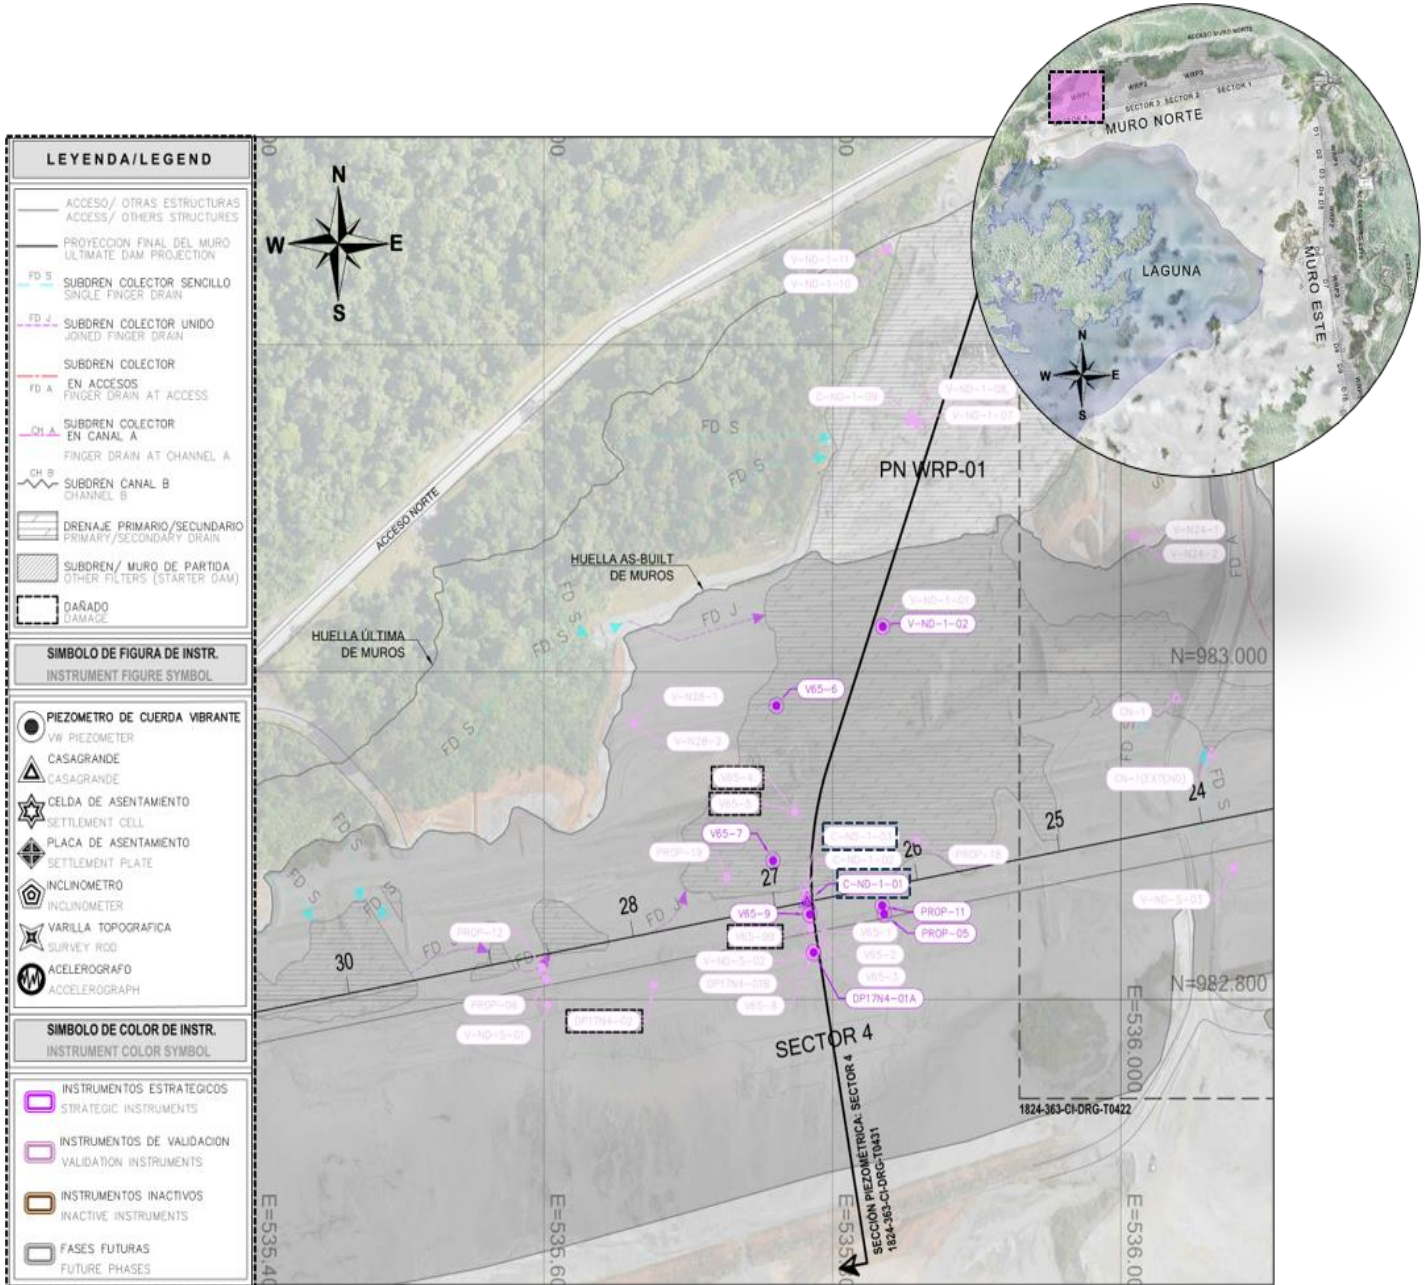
Vista de Planta en Muro Norte Sector 4 - WRP1 con Piezómetros
